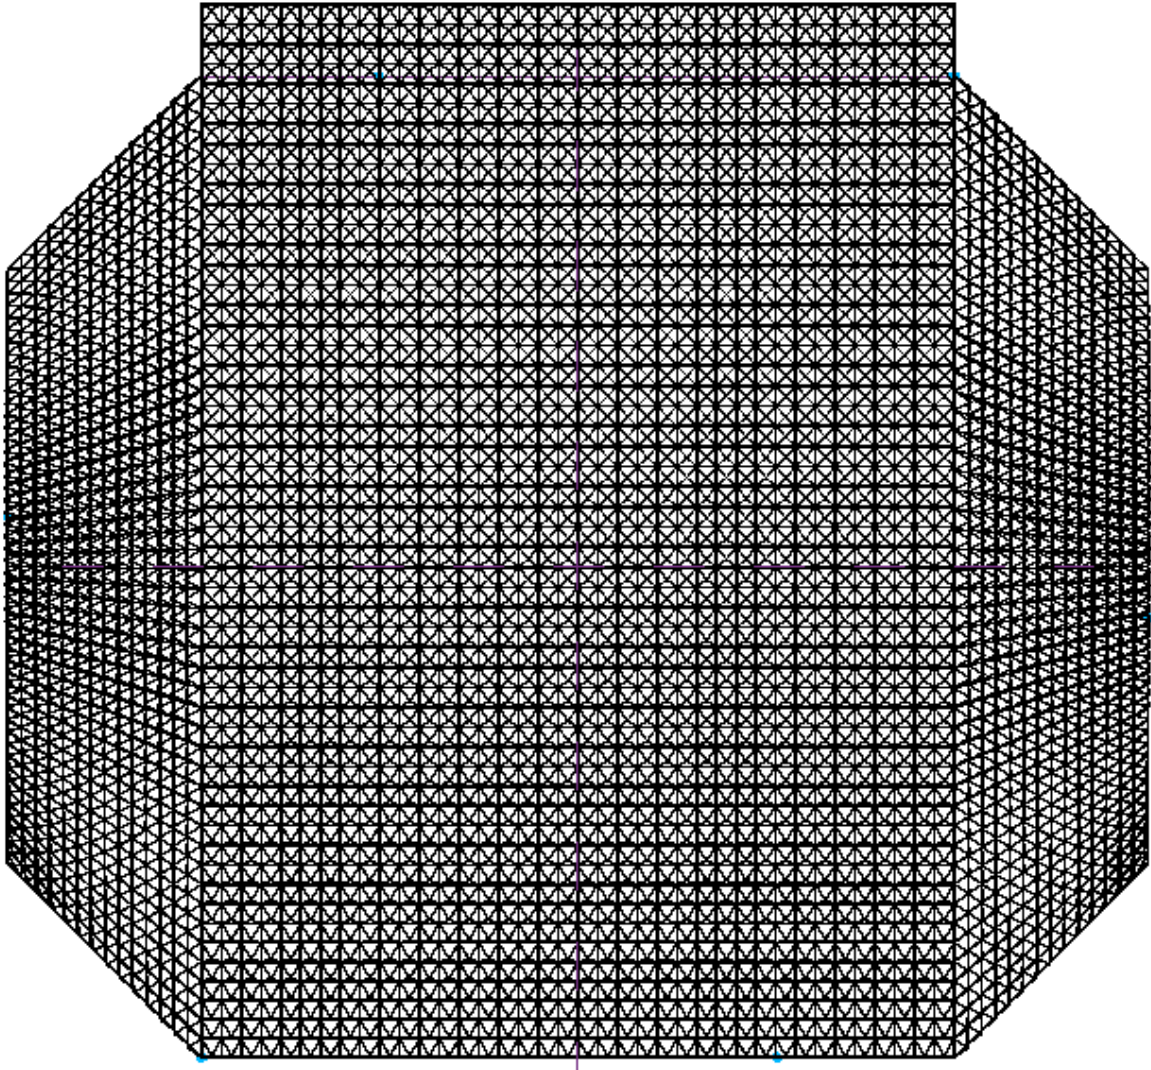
Vista en planta del diseño estructural del techo. Fuente: elaboración propia.
